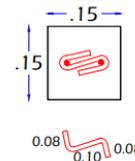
Despiece de columneta (0.15m x 0.15m)
